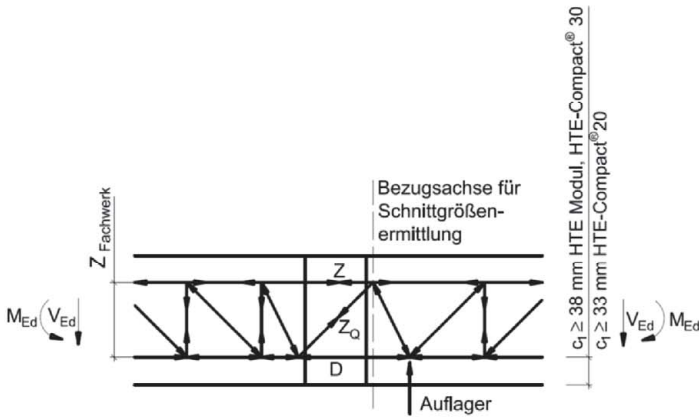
Schöck Isokorb® Typ K, K-F (Variante mehrteilig) mit Druckelementen aus Beton
